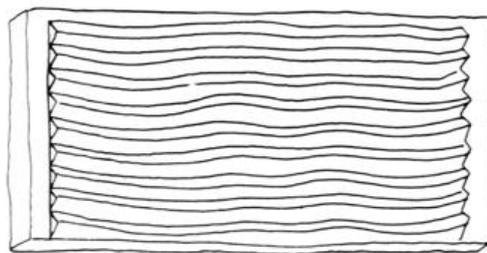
Fixação por colagem contínua com talocha dentada [4]
